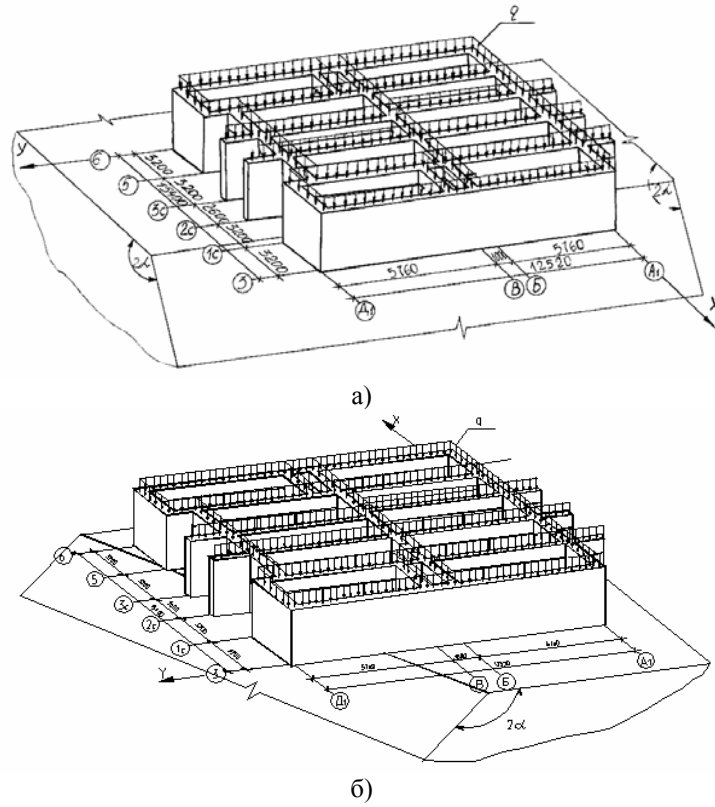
Железобетонный фундамент в виде системы перекрестных балок на упругом клиновидном основании:
